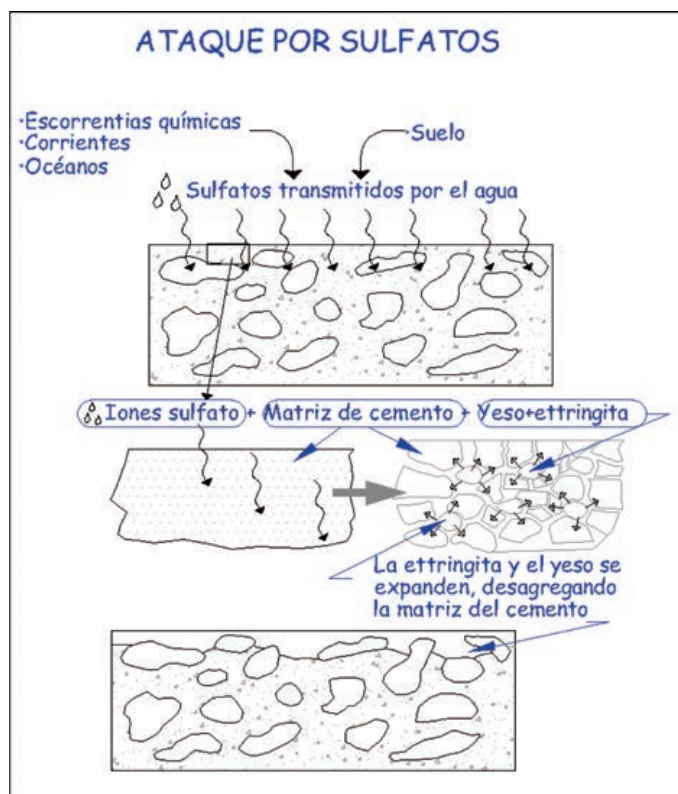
ESQUEMA DE ATAQUE POR SULFATOS EN EL HORMIGÓN.
